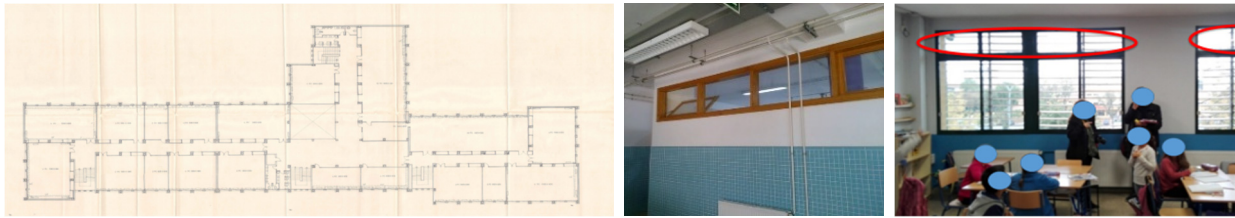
Edificios escolares a) izda: planta tipo, b) centro: montantes a pasillo; c) dch: ventanas en fachada.
